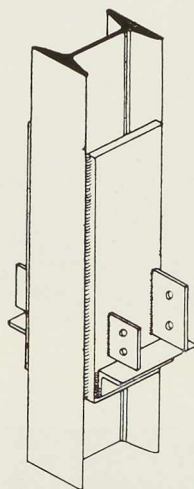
Poteau prêt à recevoir les entretoises et les poutres porte-mur.
